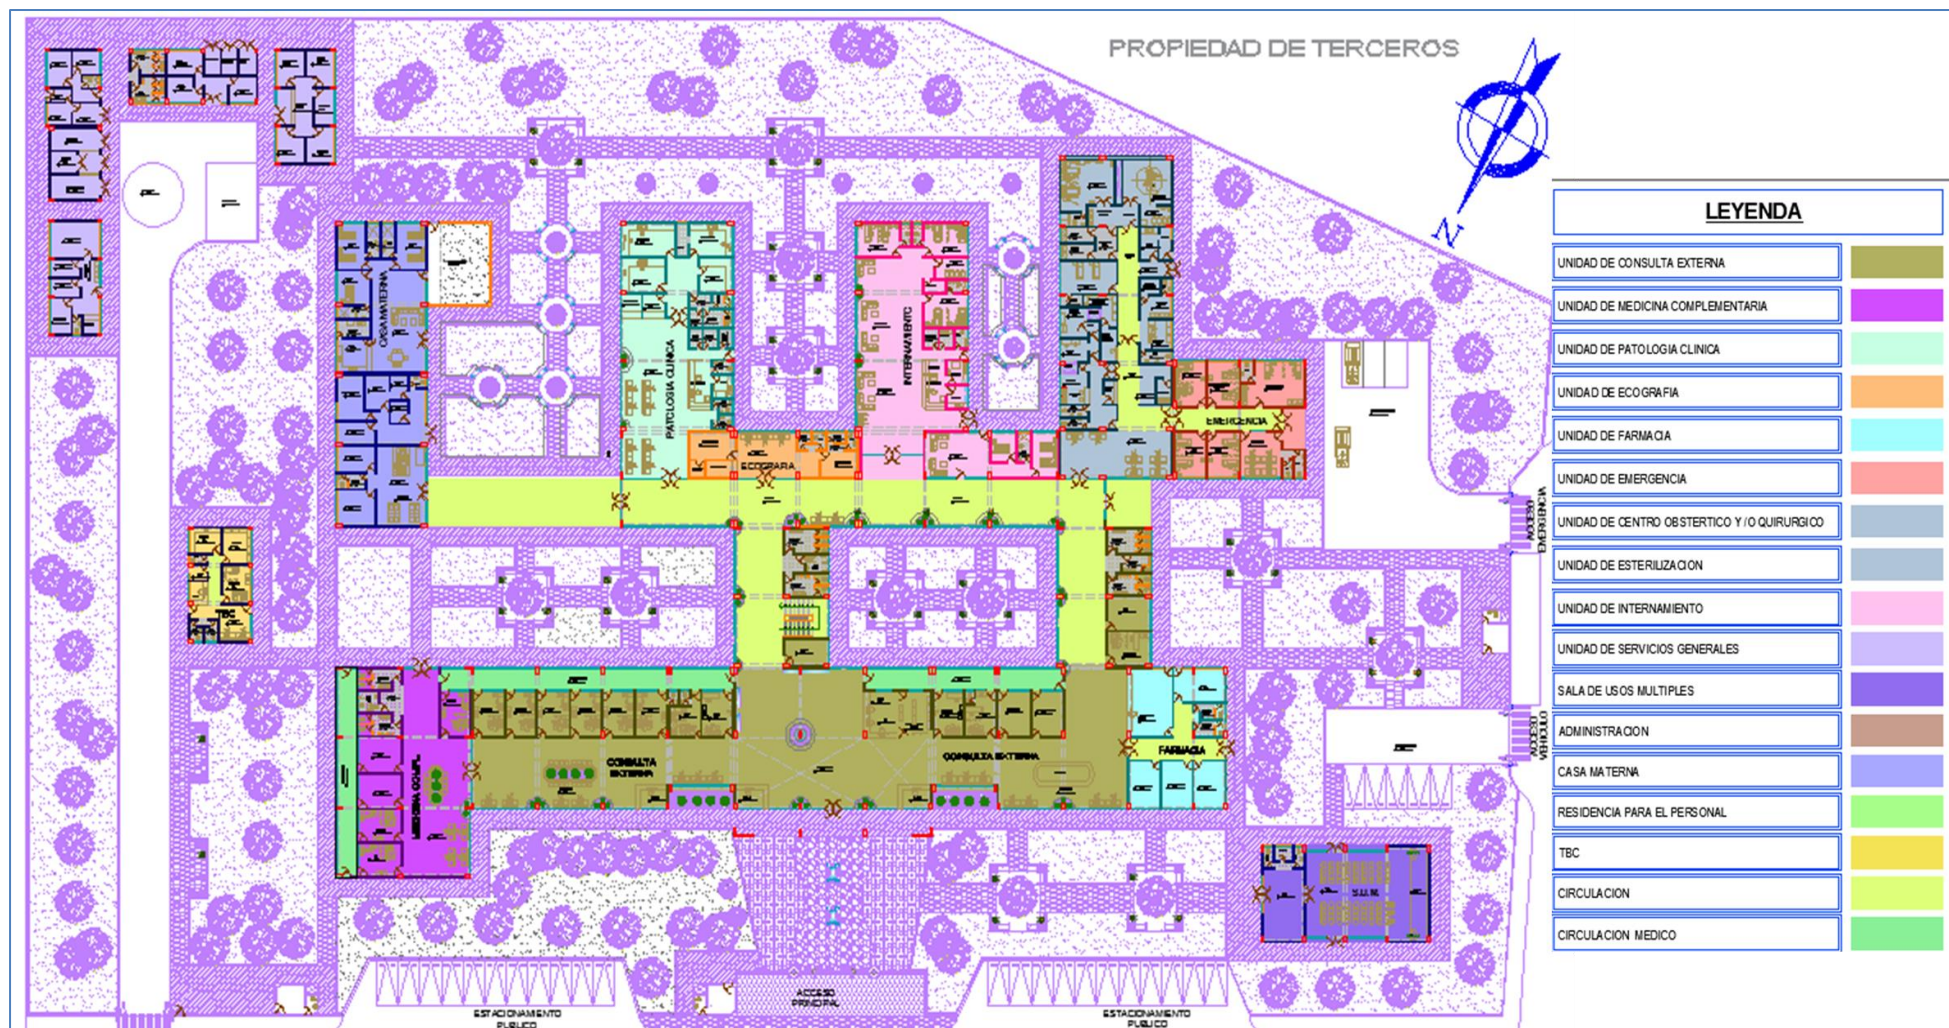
Zonificación 1° planta; Fuente: elaboración propia.
